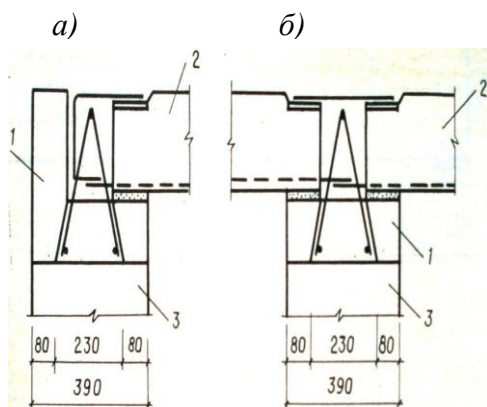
Анкеровка плит перекрытия в АС поясе сборной конструкции по наружной (а) и внутренней (б) стене: 1 – сборный пояс; 2 – плита перекрытия; 3 – стена [80, с. 220].
